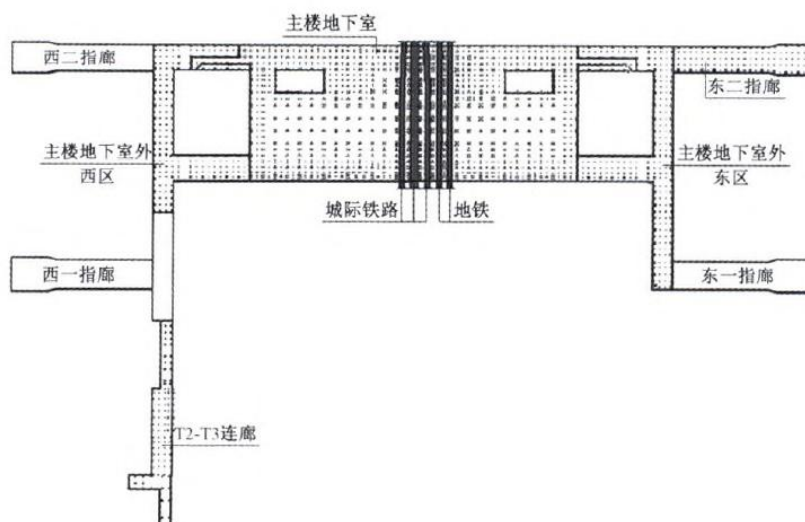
T3 航站楼城际铁路、地铁平面布置
